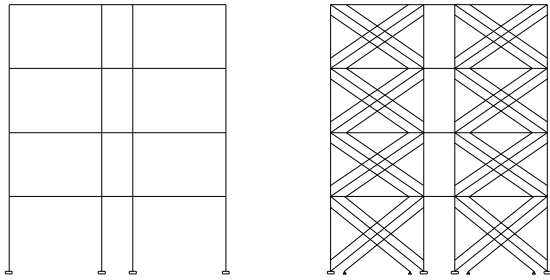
Denah gedung struktur baja dan penempatan dinding pengisinya
